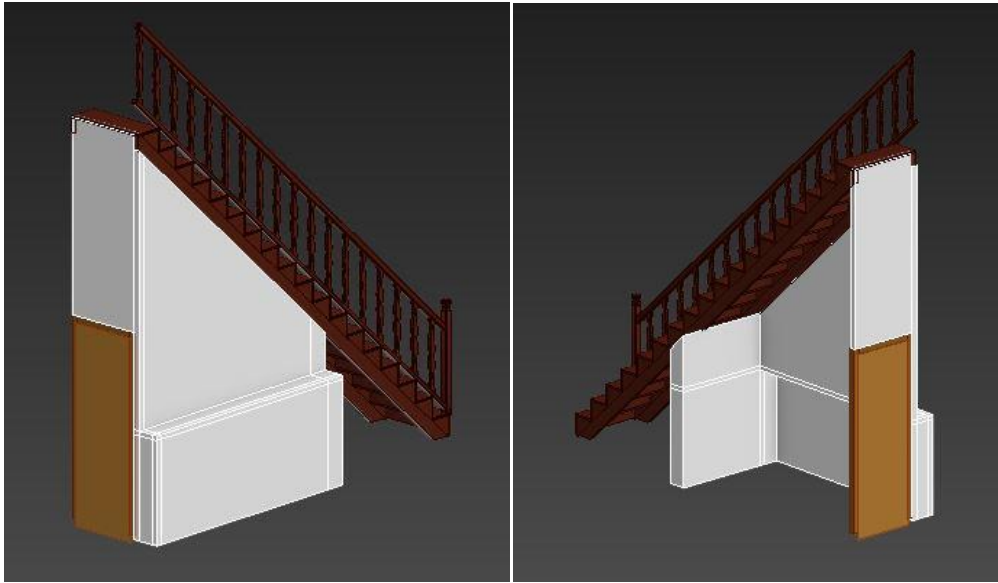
Vista de la estructura de acceso a la planta primera, y que sostiene la escalera de acceso a la planta segunda.
